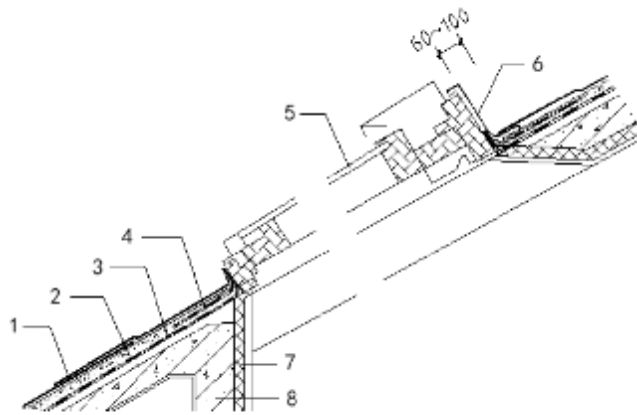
沥青瓦屋面屋顶窗防水构造
